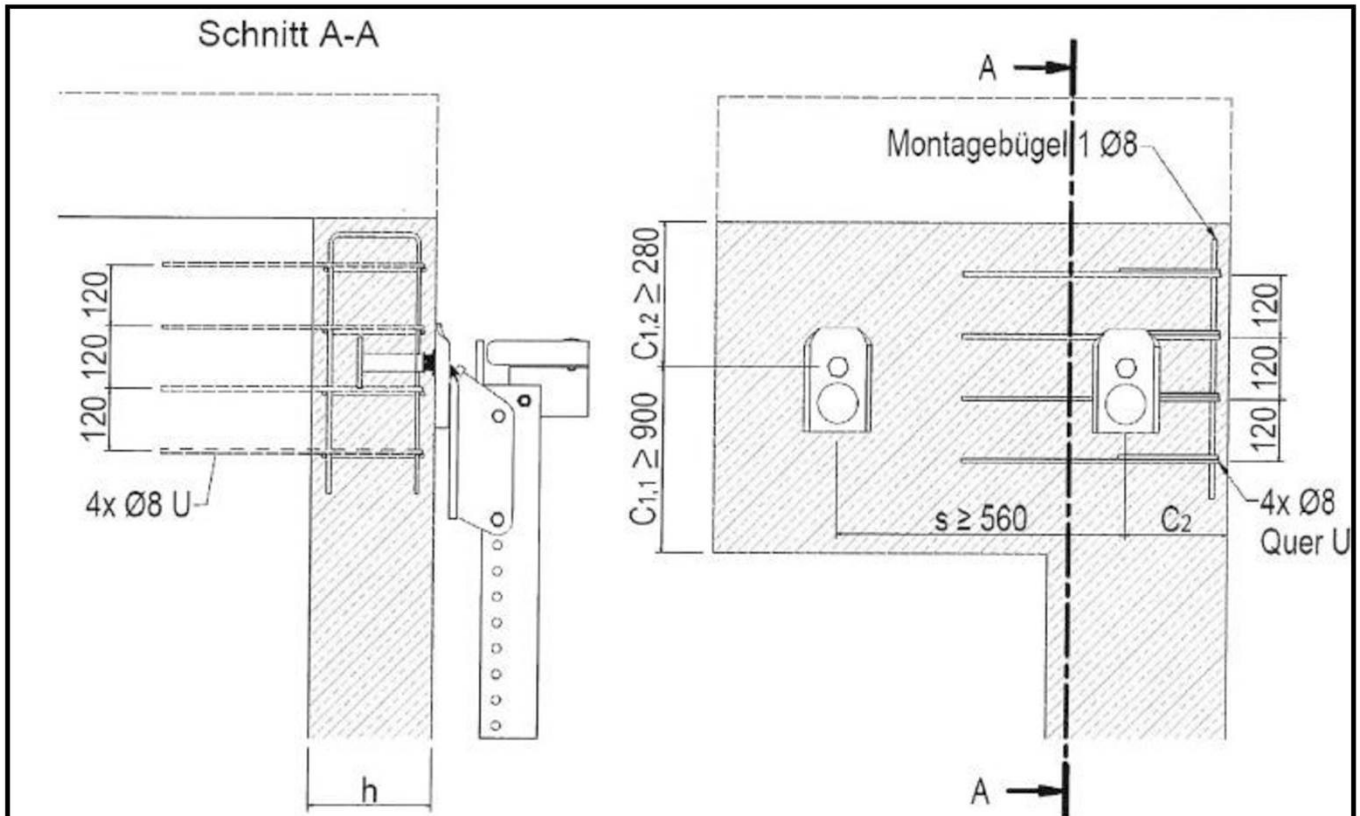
(Mindest-) Abstände der Gerüstverankerung und Mindestbewehrung der Bauteilränder (B500B) Wandaußenecke
